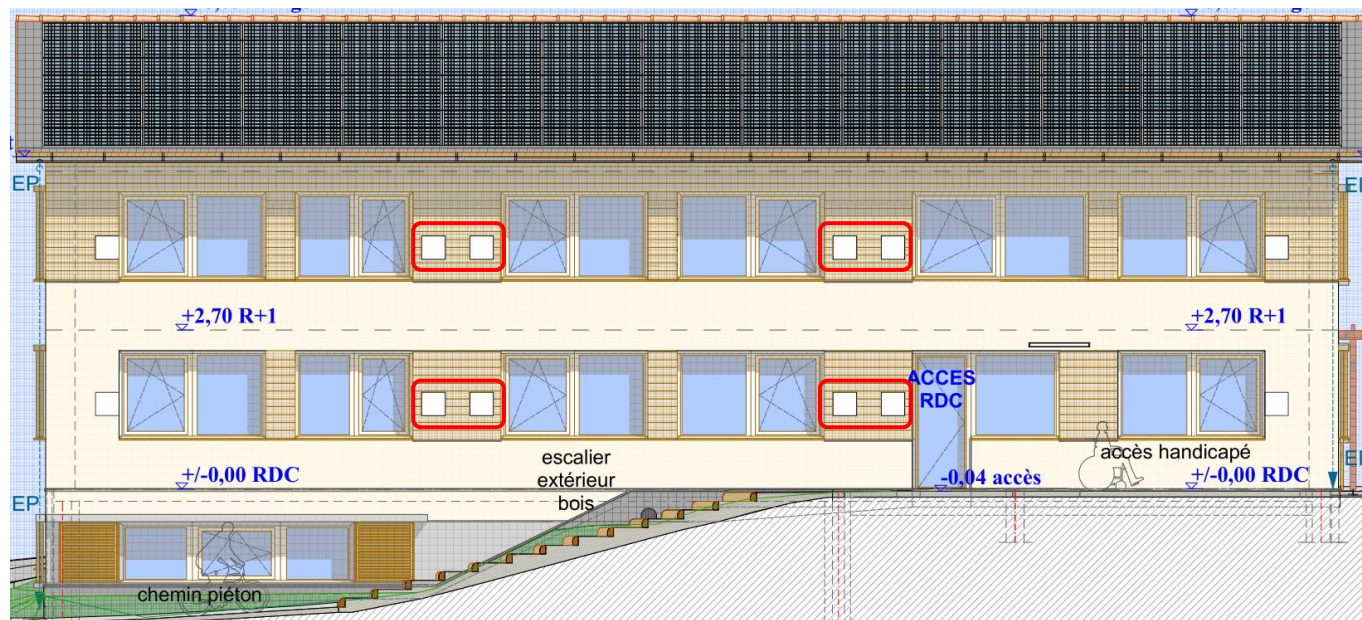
Gains de ventilations passant dans les croix de saint André (en rouge) façade sud
